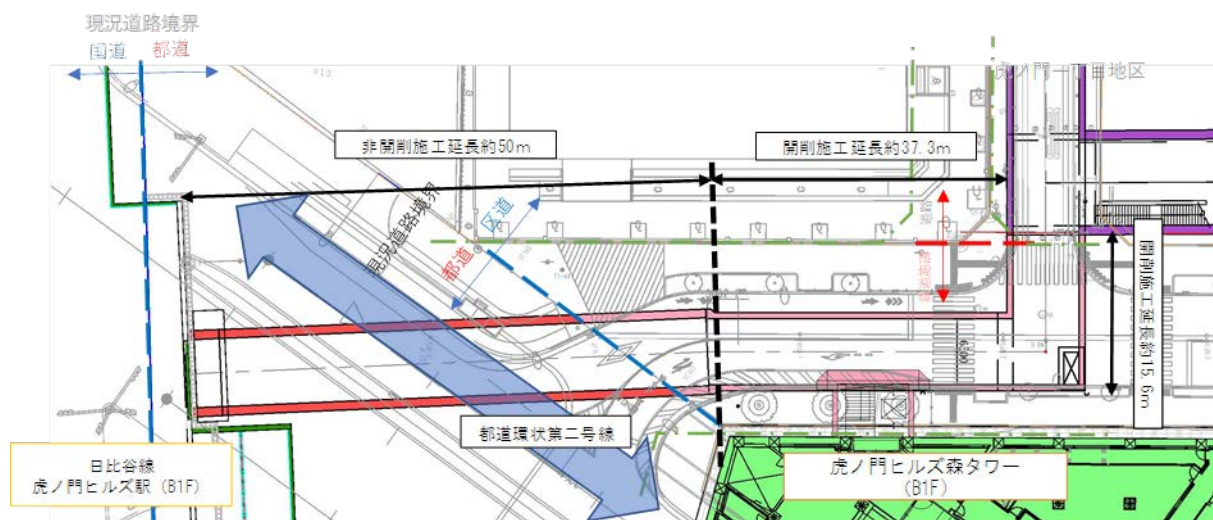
地下歩行者通路（東京メトロ施工監理実施部分）平面図
